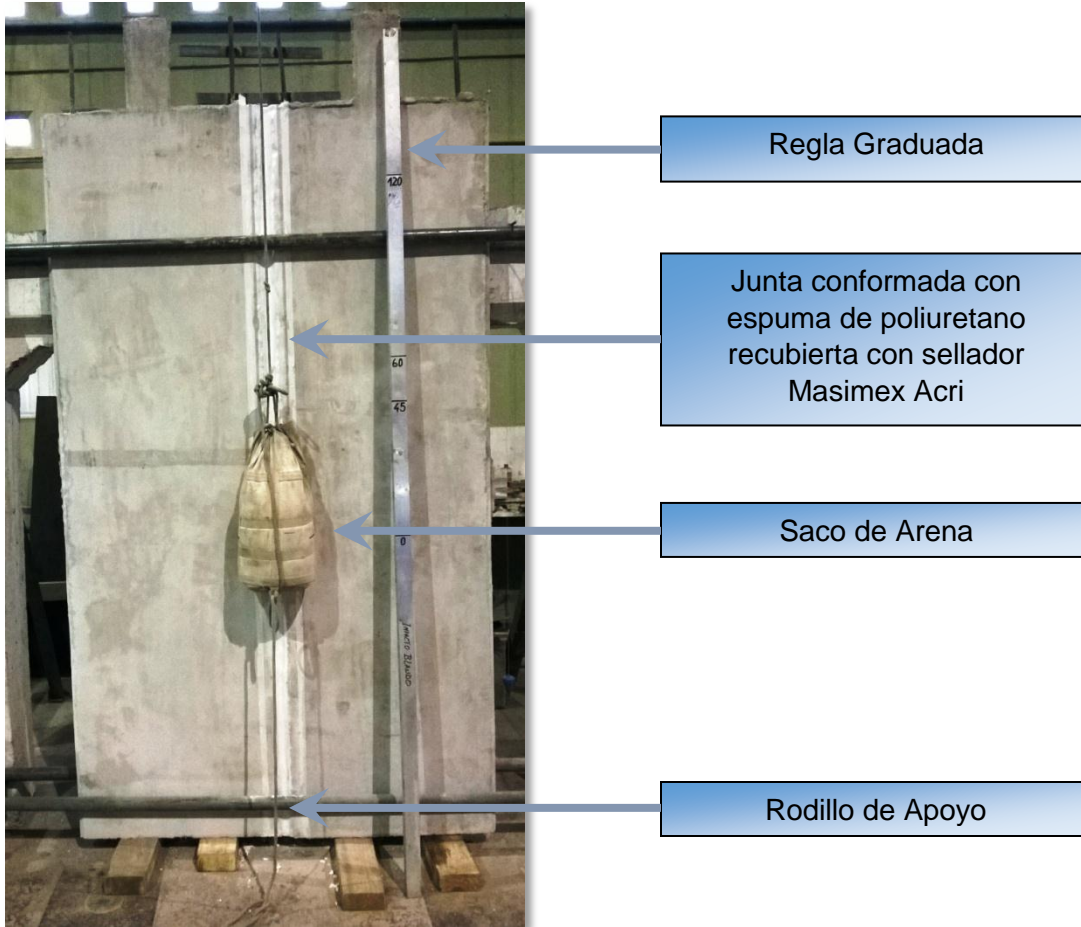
Detalle Ensayo en Junta IRAM 11.596.
